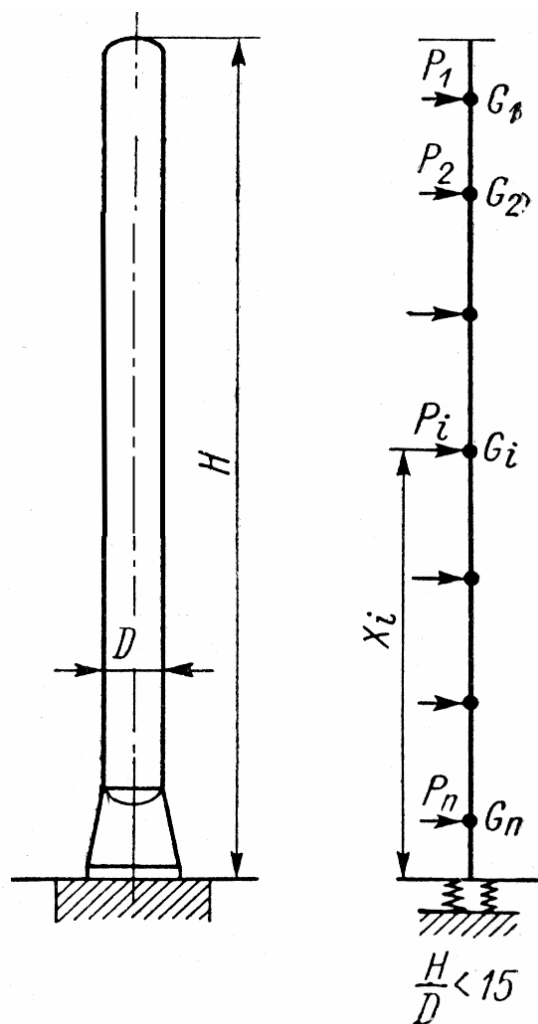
Схема к расчету аппарата на ветровую нагрузку
